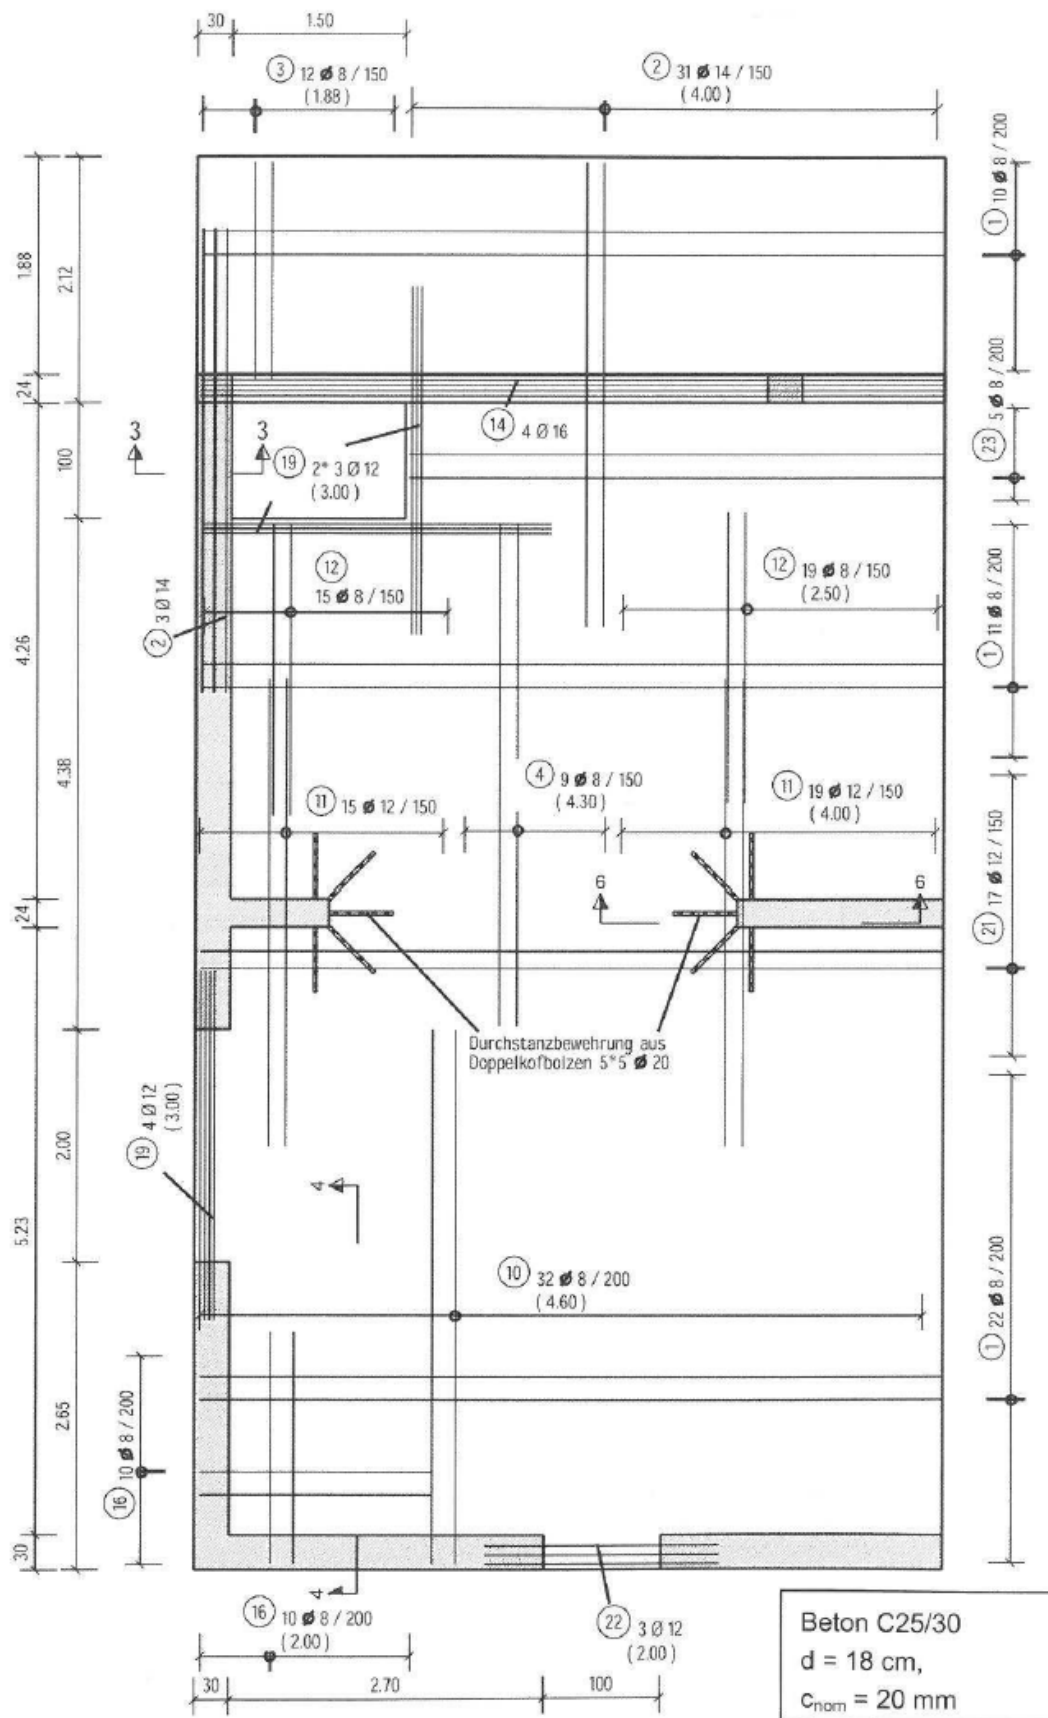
Bewehrungsführung in der Deckenplatte (obere Bewehrung)
